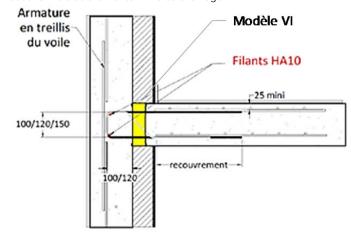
Coupe plancher béton armé/façade (Rupteur VI) (le doublage est réalisée selon les prescriptions de l'Annexe 9)
